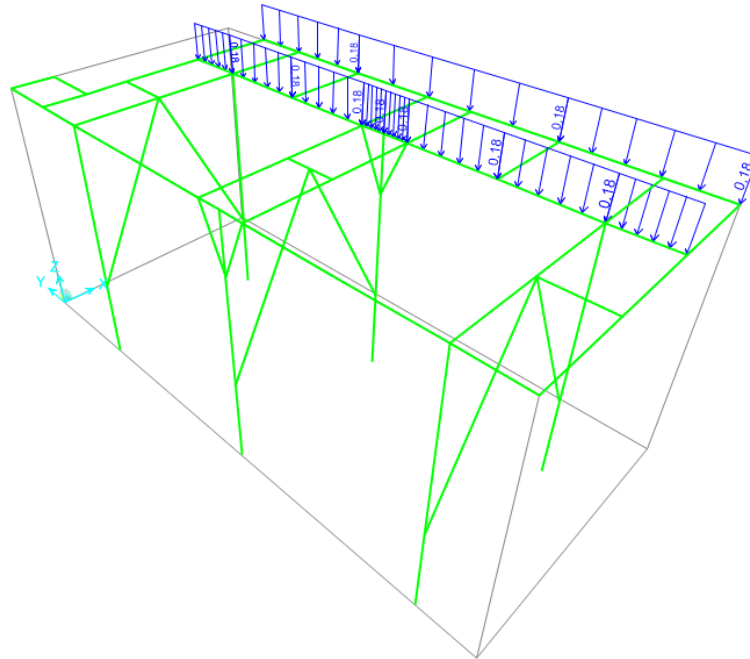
Aplicación de cargas peso de plancha zona 3
